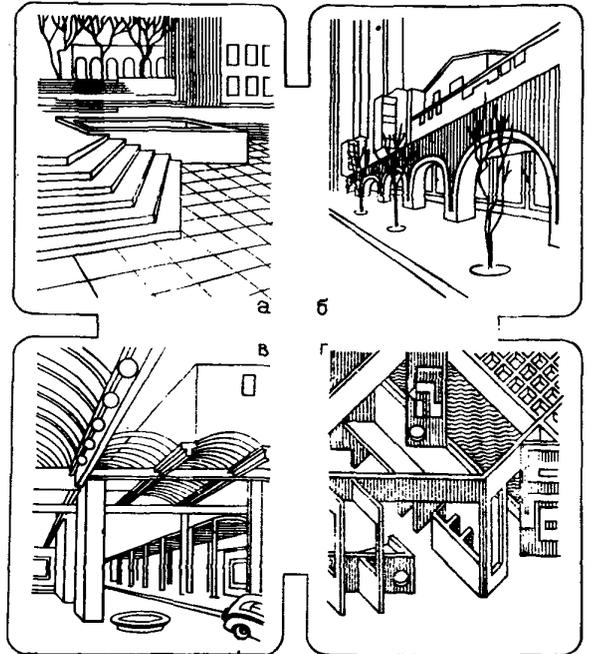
Решение крупными архитектурными приемами основных составных частей общественного пространства а — основания; б — основных ограждений; в — перекрытия; г — условных перегородок
